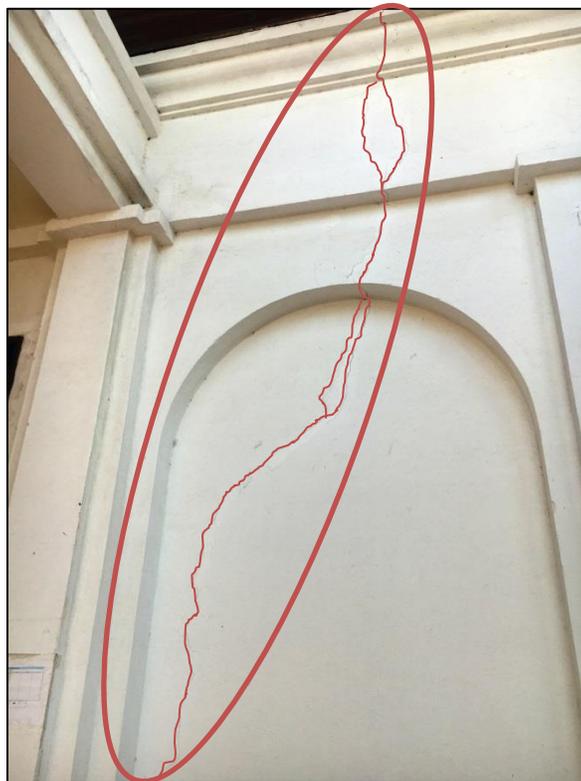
Teatro zona platea – Muros fisurados – Fachada lateral derecha.
